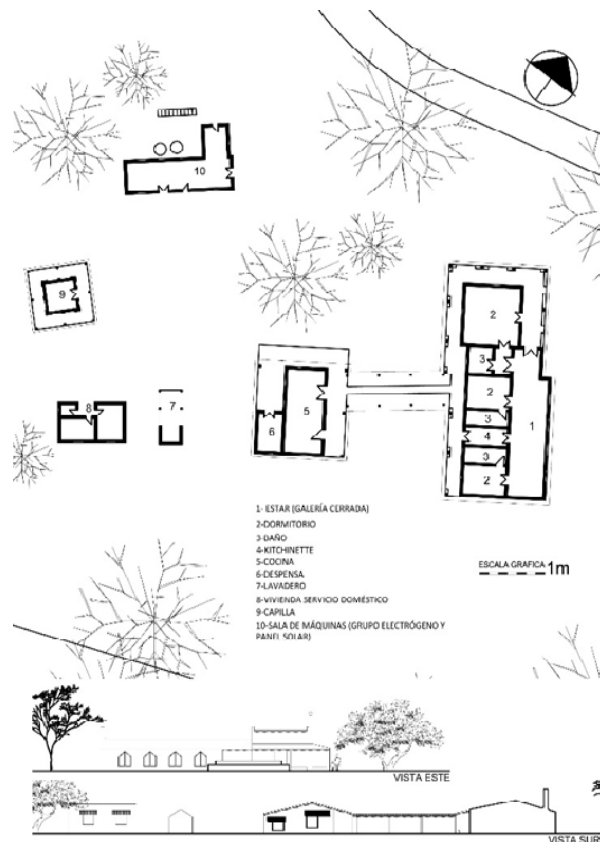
Casco principal de Santa Juana. Planta y vistas del sector principal
